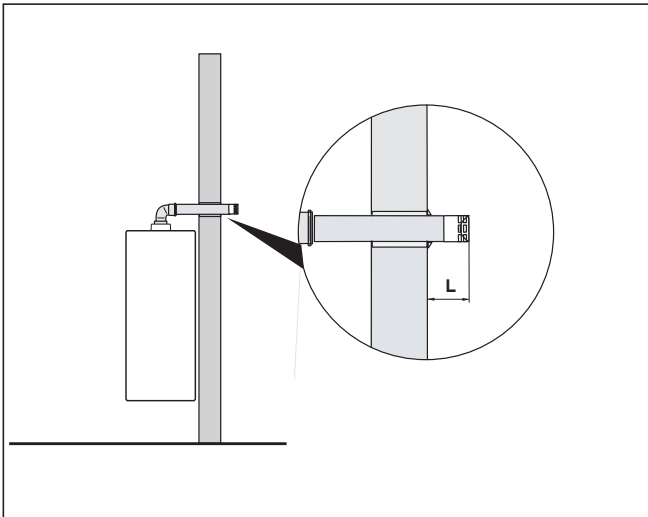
Distanza tra la parete e la protezione antivento con l'esempio del passante a tetto orizzontale
